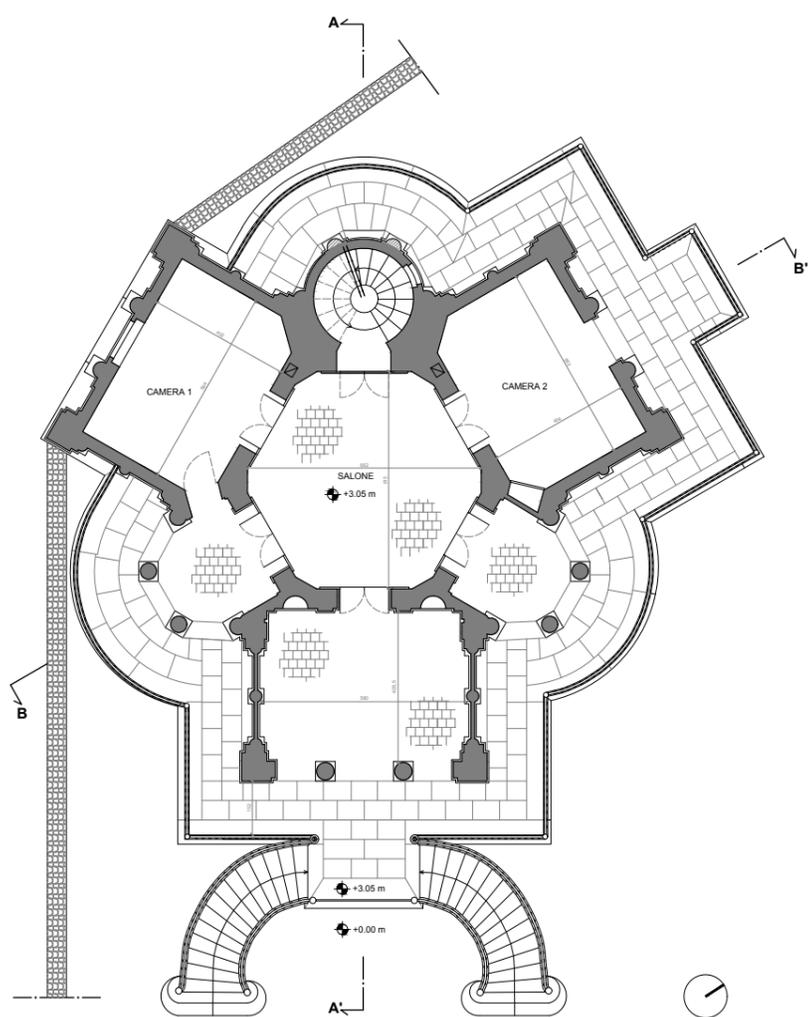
\_Pianta piano primo La Bizzarria-scala 1:200
